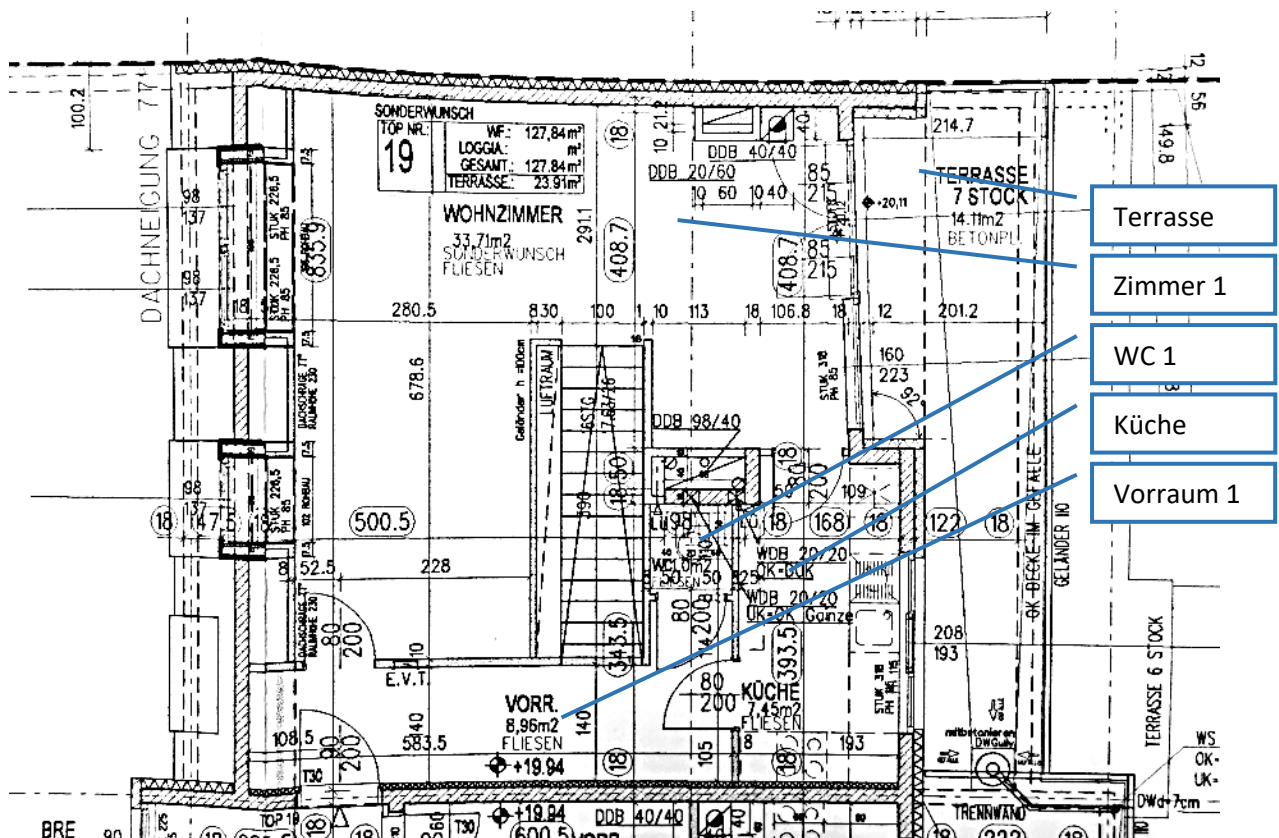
Auszug Bestandsplan (Fertigstellungsanzeige), 2.DG, Plan Nr.: 9
